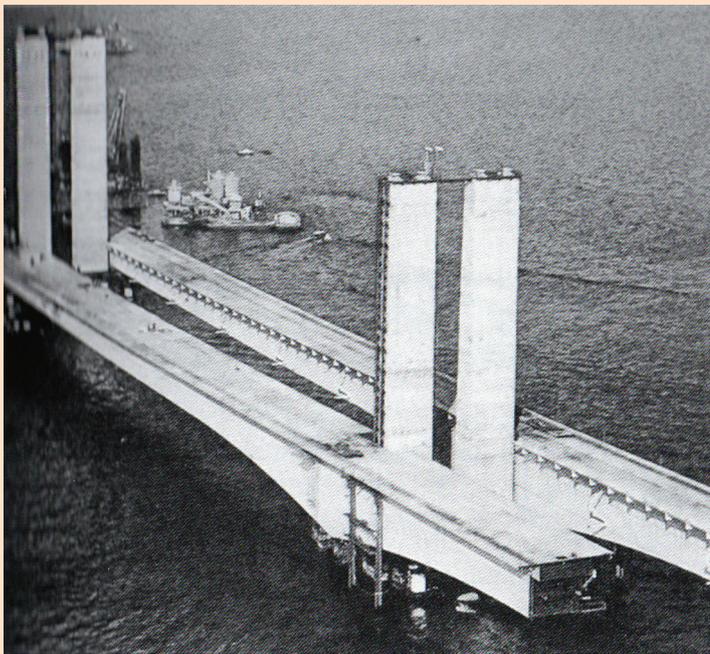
INÍCIO DO IÇAMENTO DA ESTRUTURA METÁLICA [10]
